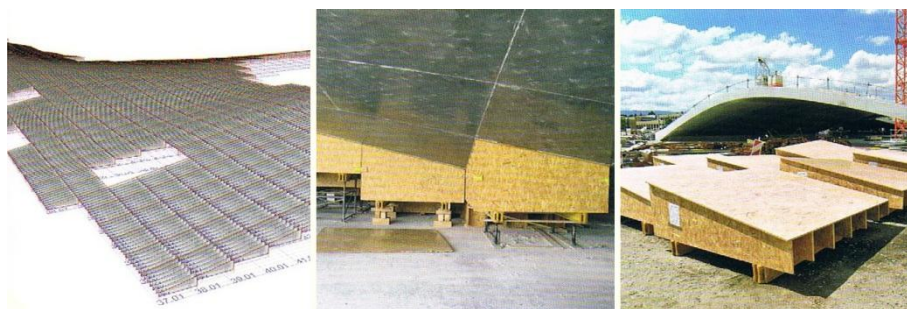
Modelação 3D para a construção e montagem das cofragens
